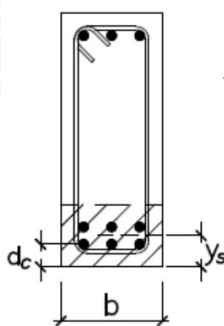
Área efectiva del concreto en tracción. Adaptado de “Apuntes del curso de Concreto Armado 1”
